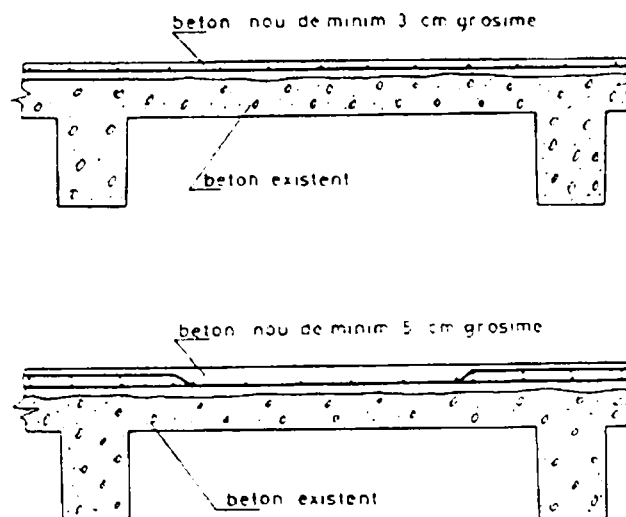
Consolidarea placilor din beton armat la partea superioara prin suprabetonare
